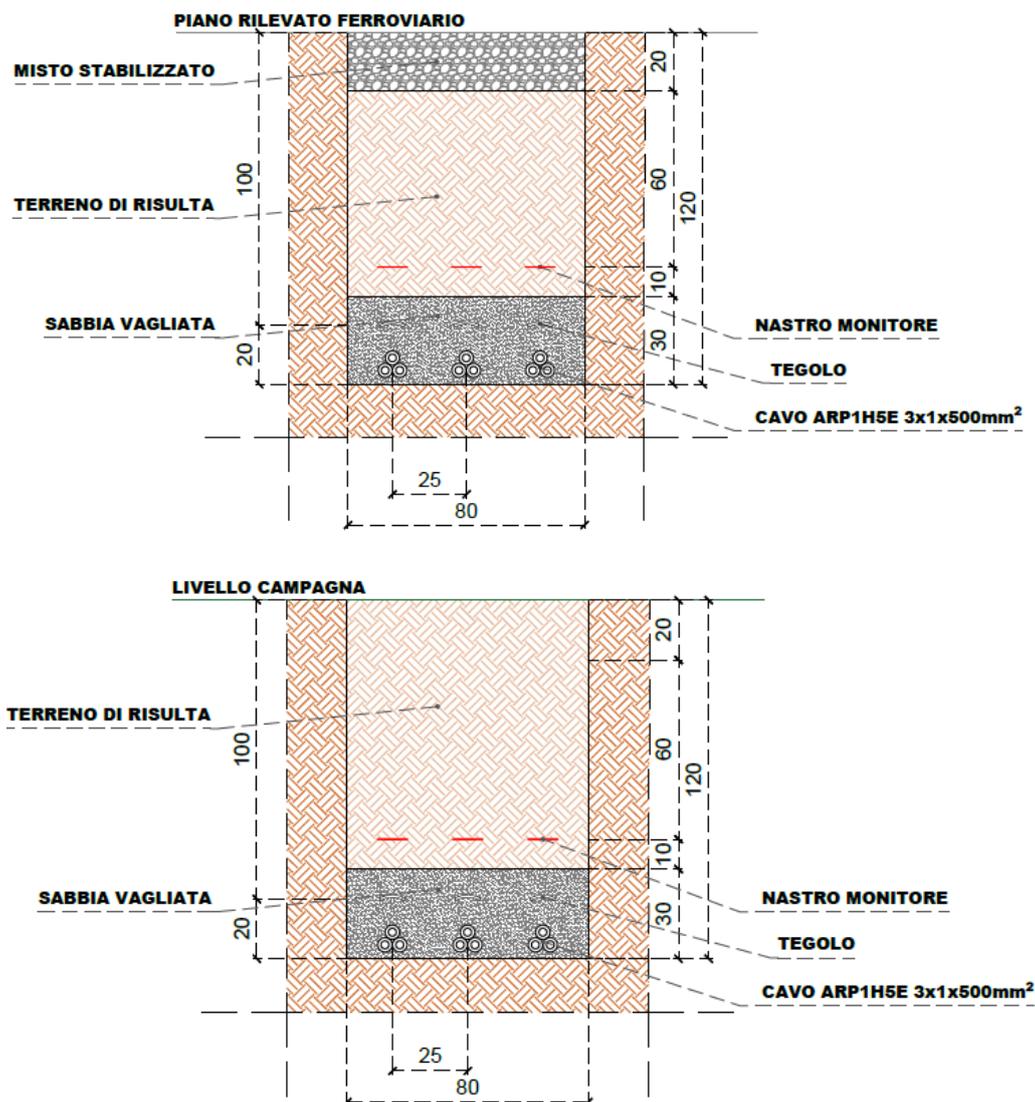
Dettaglio sezioni di scavo per posa cavidotto MT
